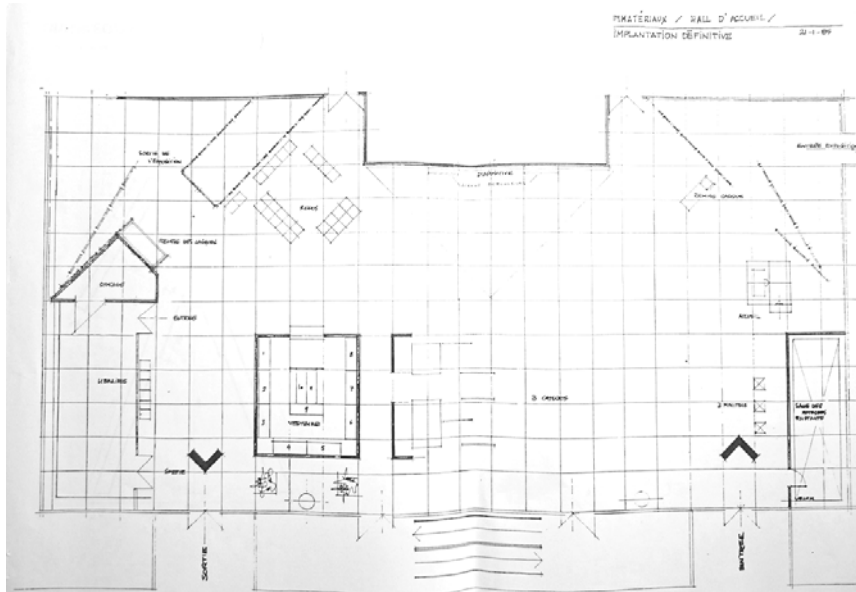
Plano de detalle de vestíbulos. Arquitecto Philippe Dèlis.
